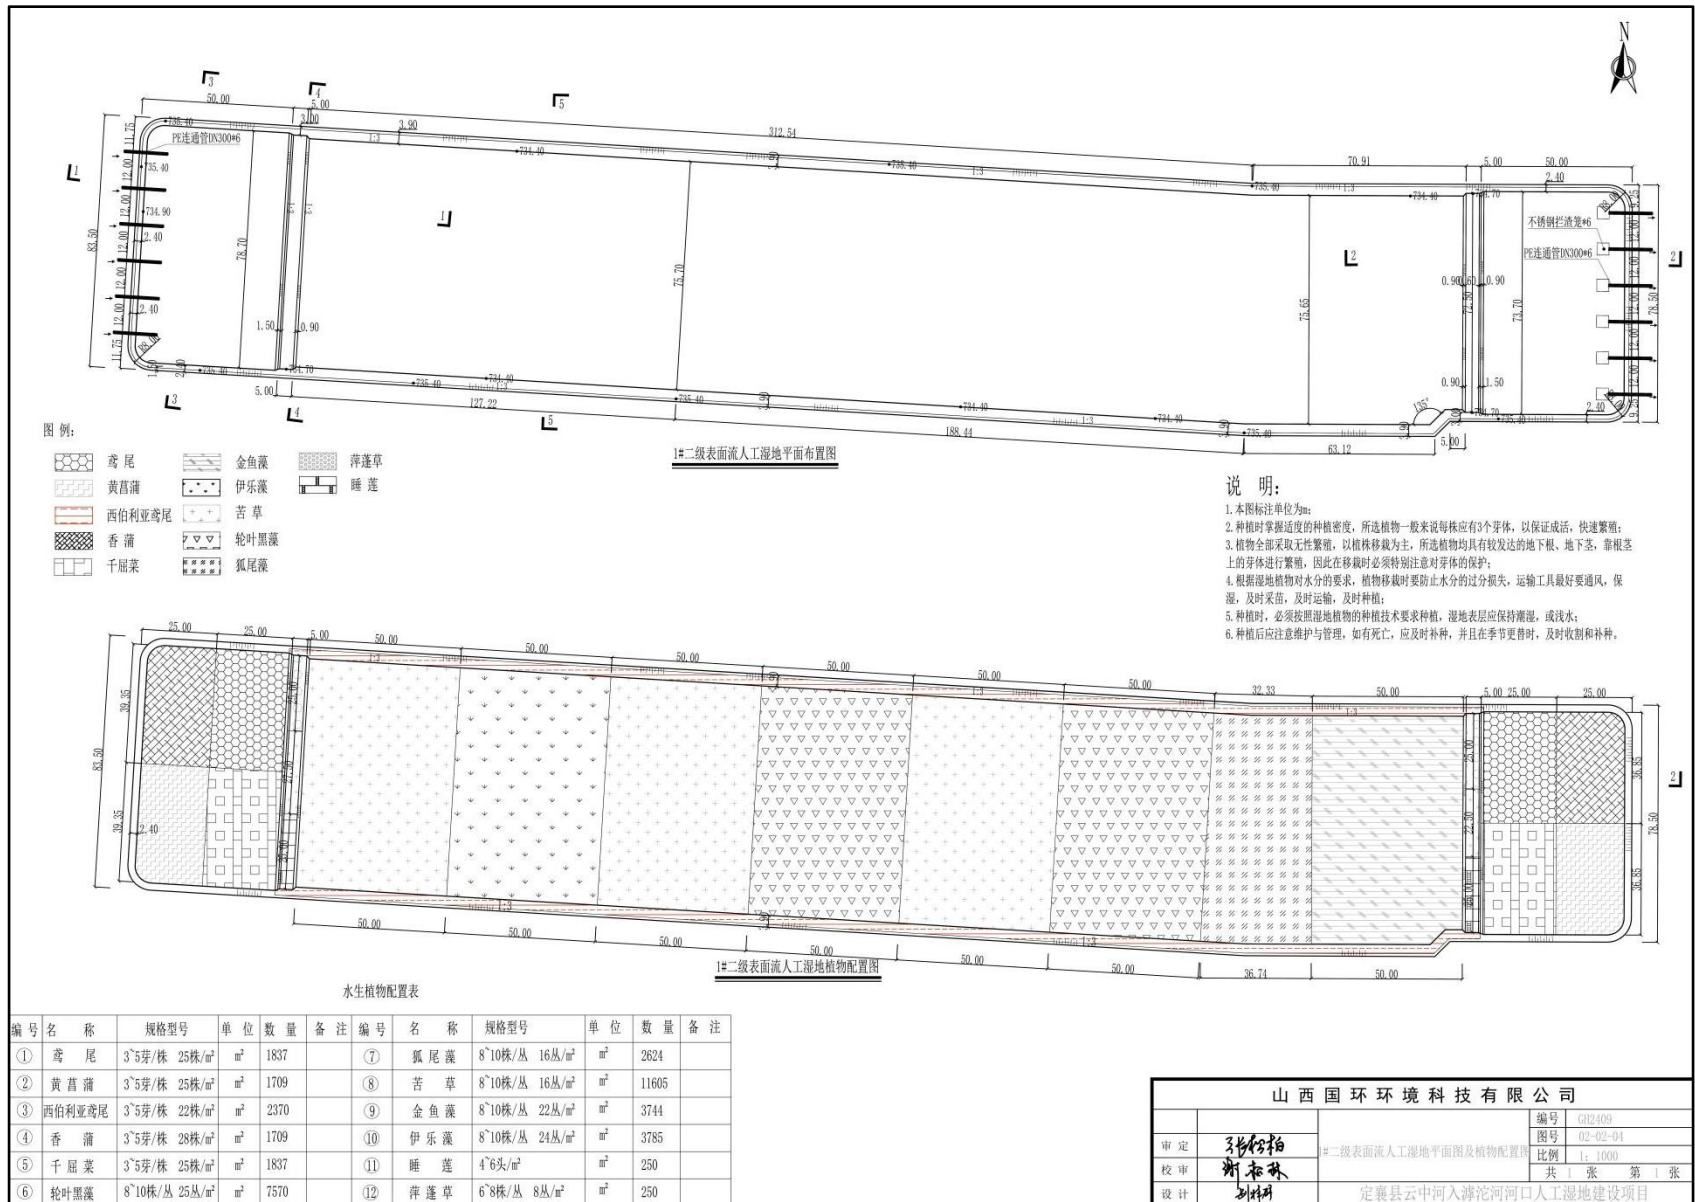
1#二级表面流人工湿地平面布置及植物配置图
